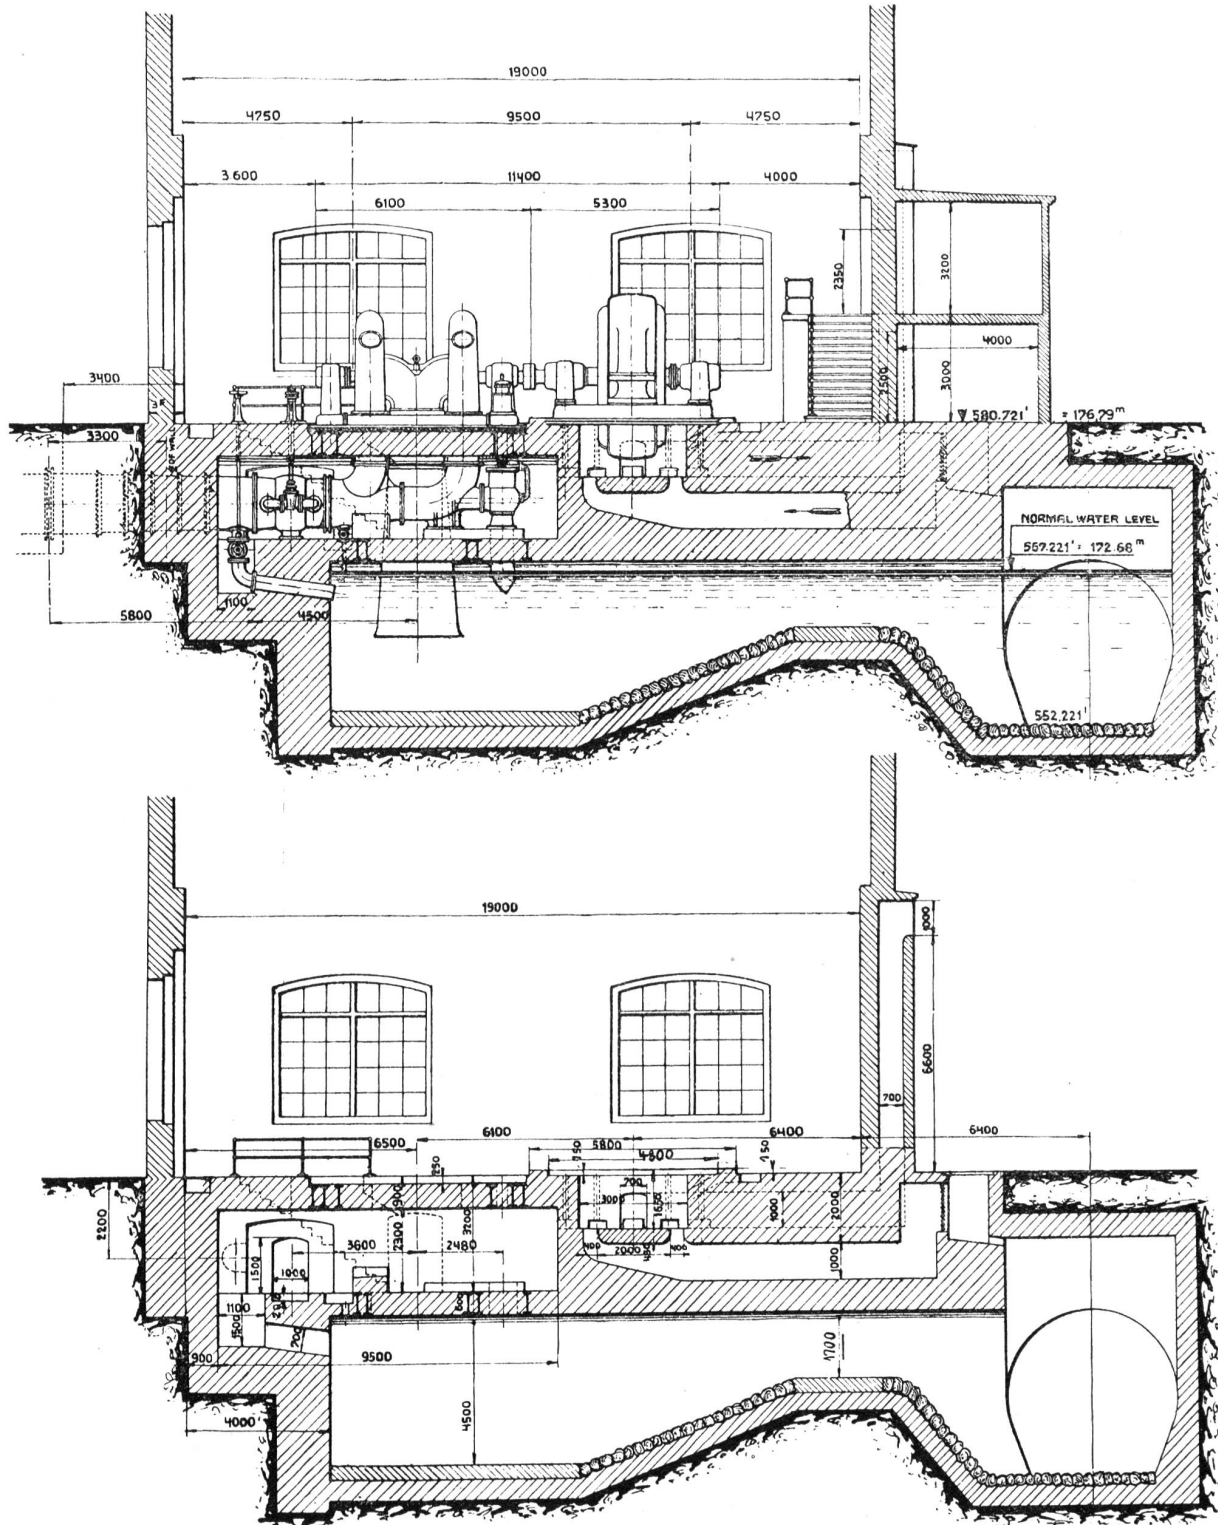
und 2. Längsschnitt und Grundriss des Krafthauses.
